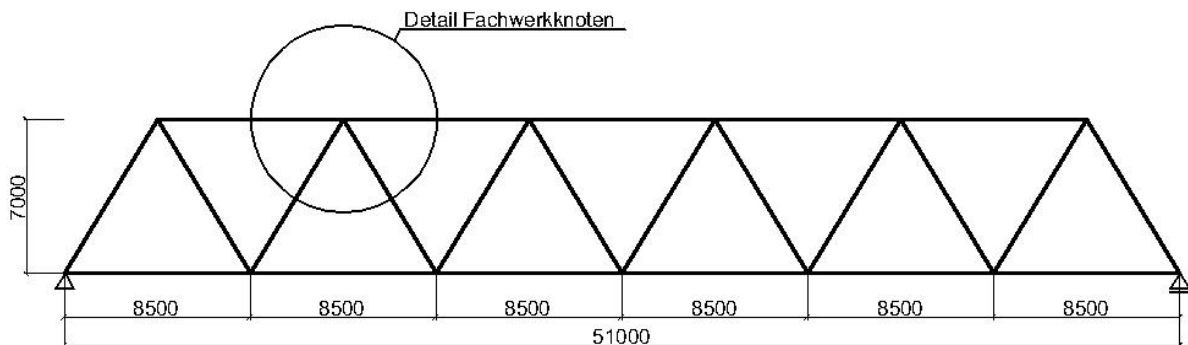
Statisches System in Brückenlängsrichtung (Maße in mm)
